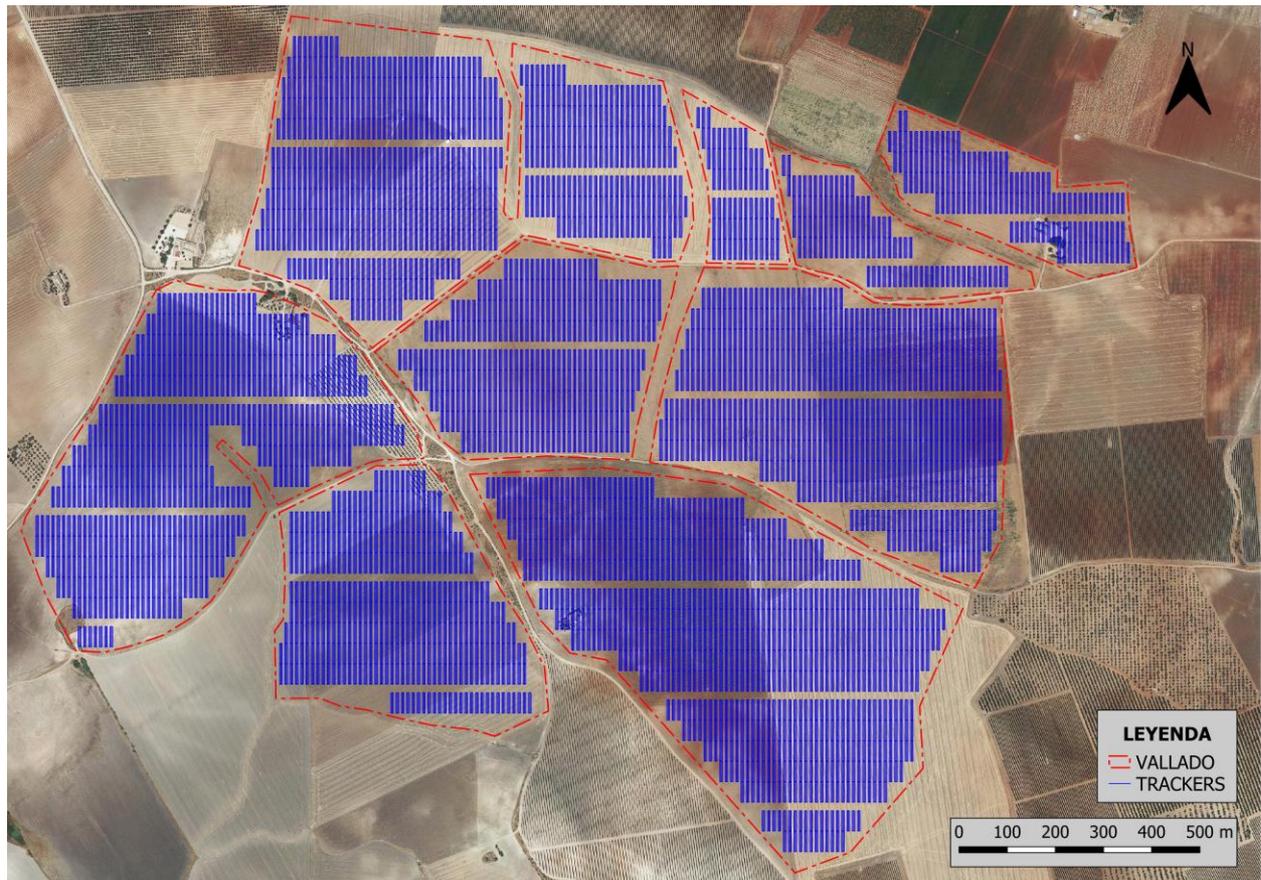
Implantación de la futura planta solar fotovoltaica “VALHALLA”
